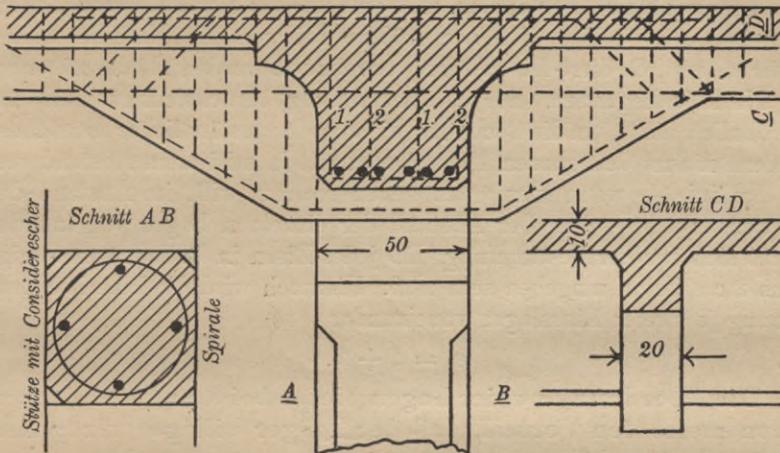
Stütze mit Unterzug und anschließenden Plattenbalken.
